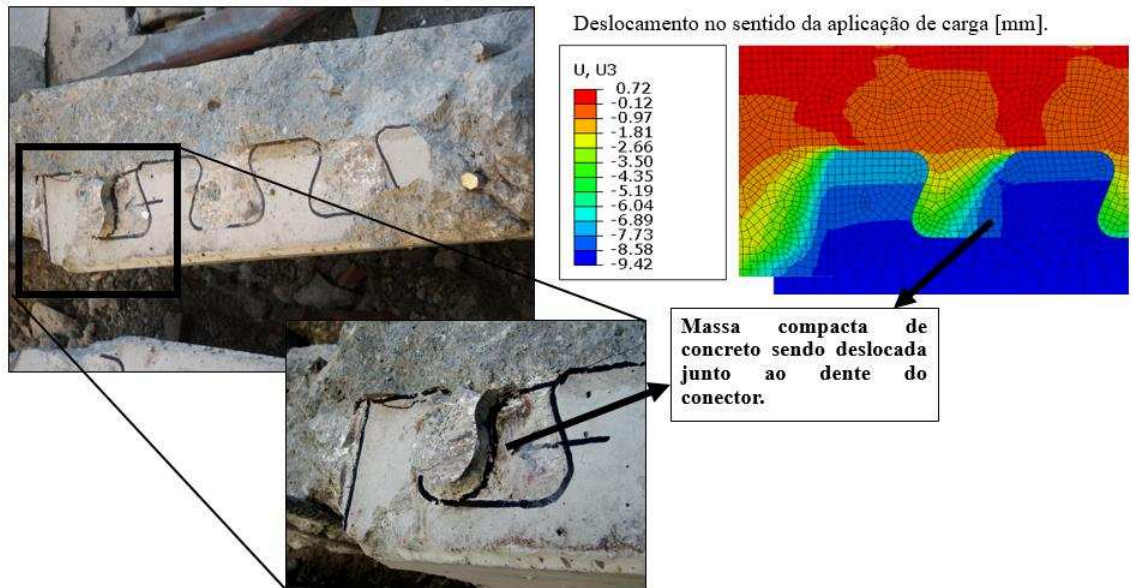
Aspecto da fissuração do concreto (modelo C1-C2).
